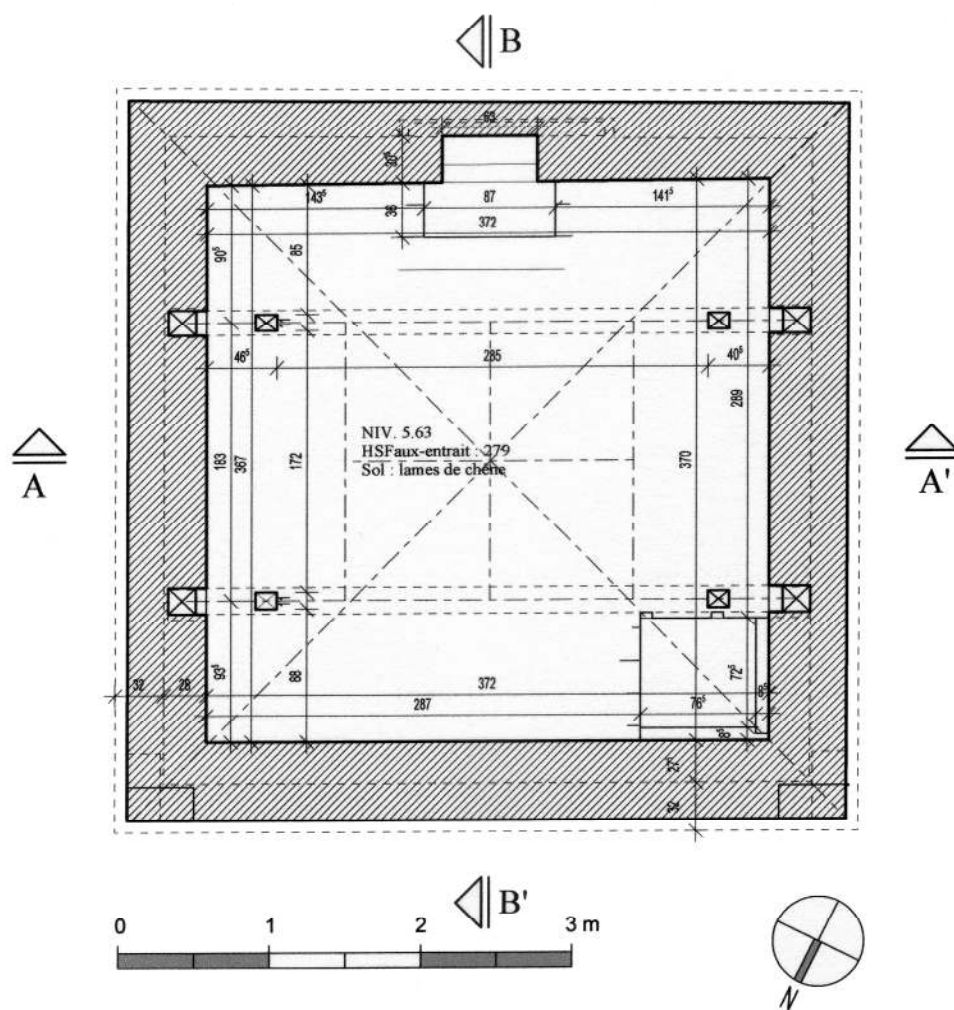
Pavillon. Vue en plan du comble. Ech. 1/50°. Etat existant. IG 2003.
